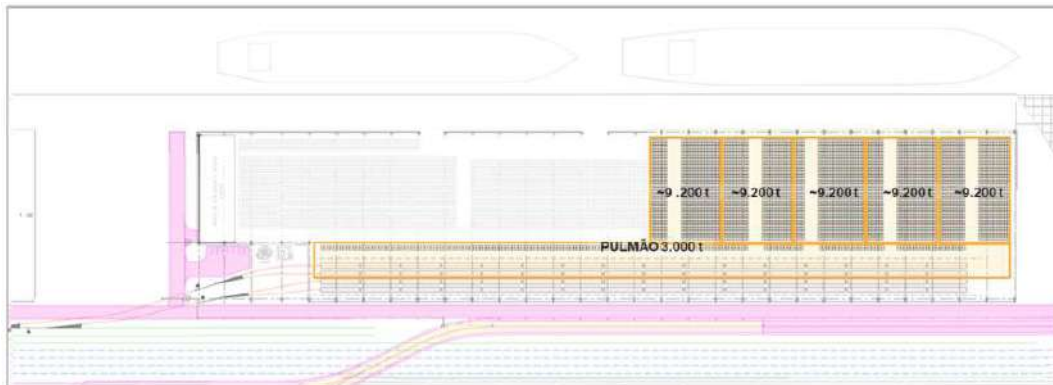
Planta do Conjunto de Armazéns Lonados.
